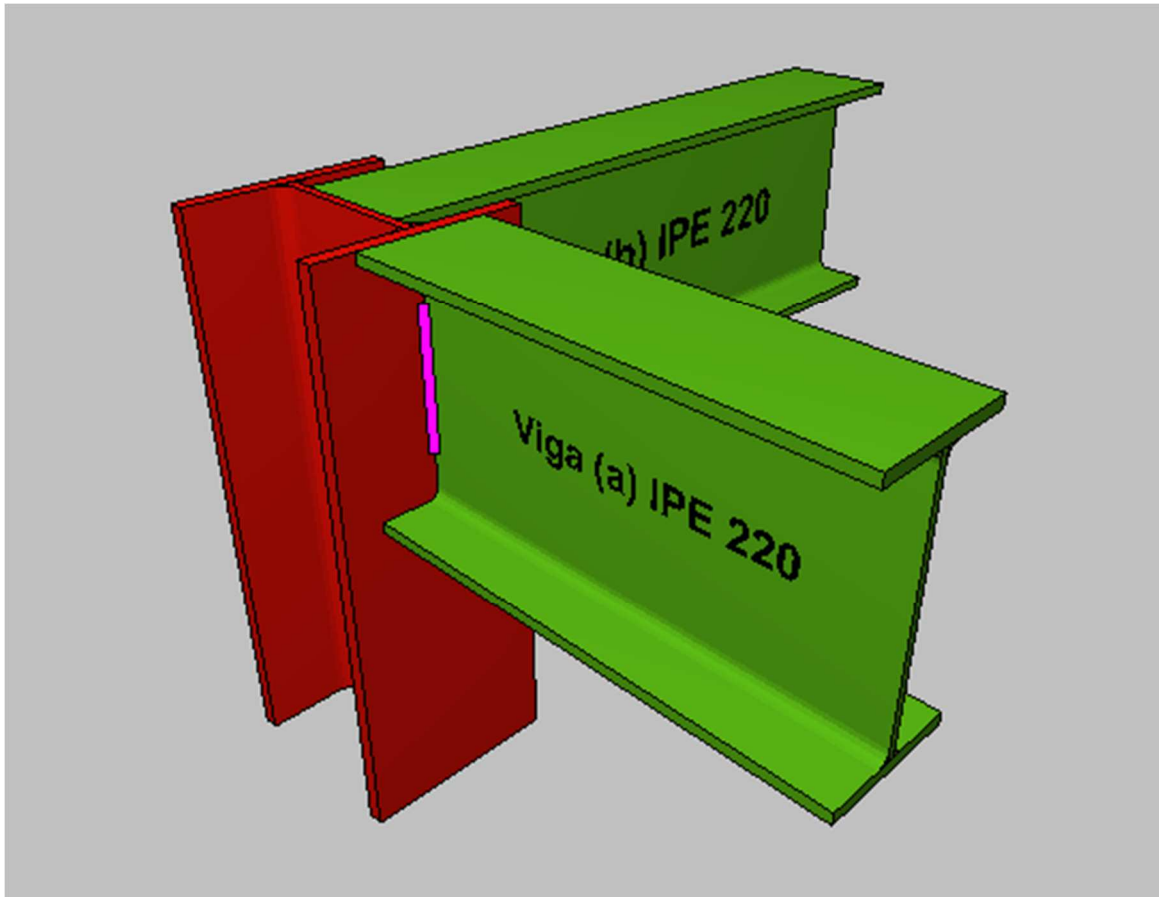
Unión tipo 3 soporte inferior. Viga-pilar-viga
